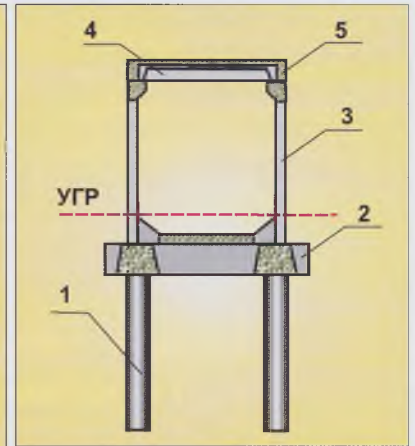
Поперечный разрез перегонного тоннеля: 1 - буронабивная свая, 2 - ростверк монолитный, 3 - стеновой блок, 4 - плита покрытия, 5 - бетонирование
